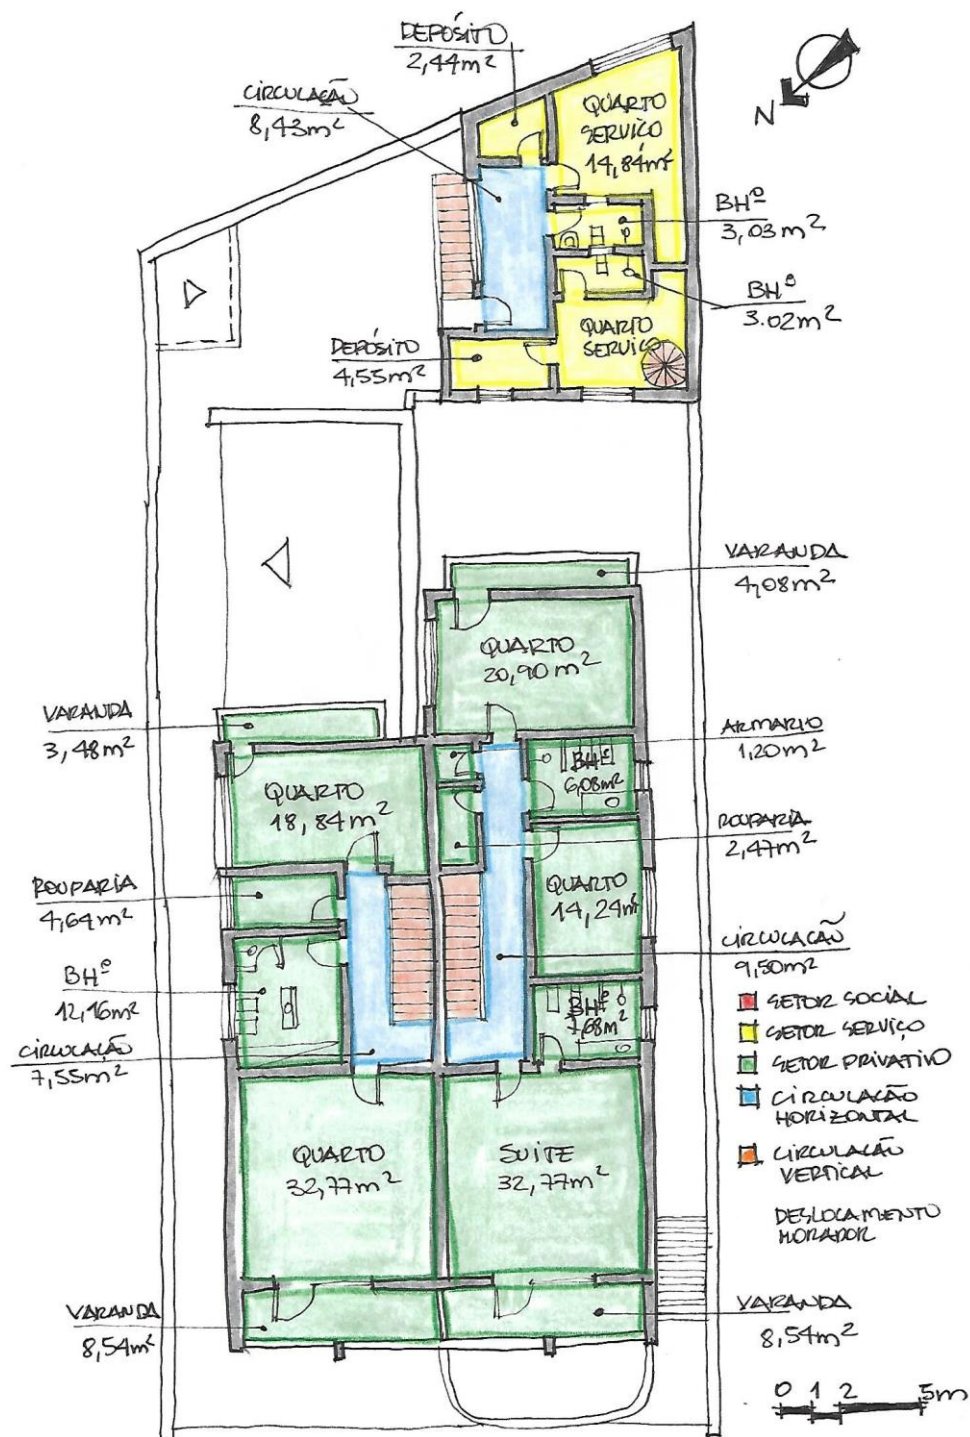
Planta do pavimento superior da Residência Nº 524. Fonte: autora, 2018.
